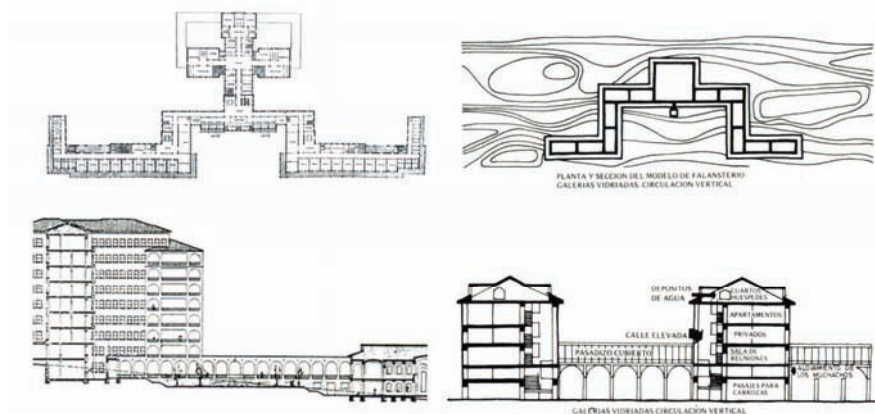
a la derecha el Sanatorio Antituberculosos de Tarrasa, planta tipo y fragmento de sección. Fuente: «Revista Nacional de Arquitectura», 1944, año III, nº 33, p. 341 y p. 338. A la izquierda el Falansterio de Fourier, planta y sección. Fuente: Roberto Segre, «Historia de la arquitectura y del urbanismo», 1985, lám. 17, p. 84.
